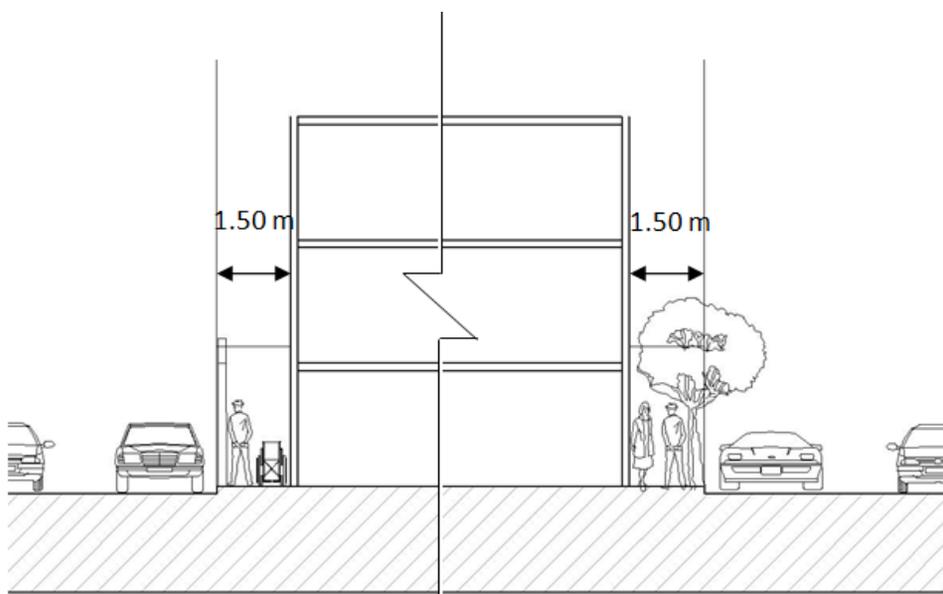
Corte esquemático con banquetas de 1.50 m de ancho. Fuente: elaboración propia.
